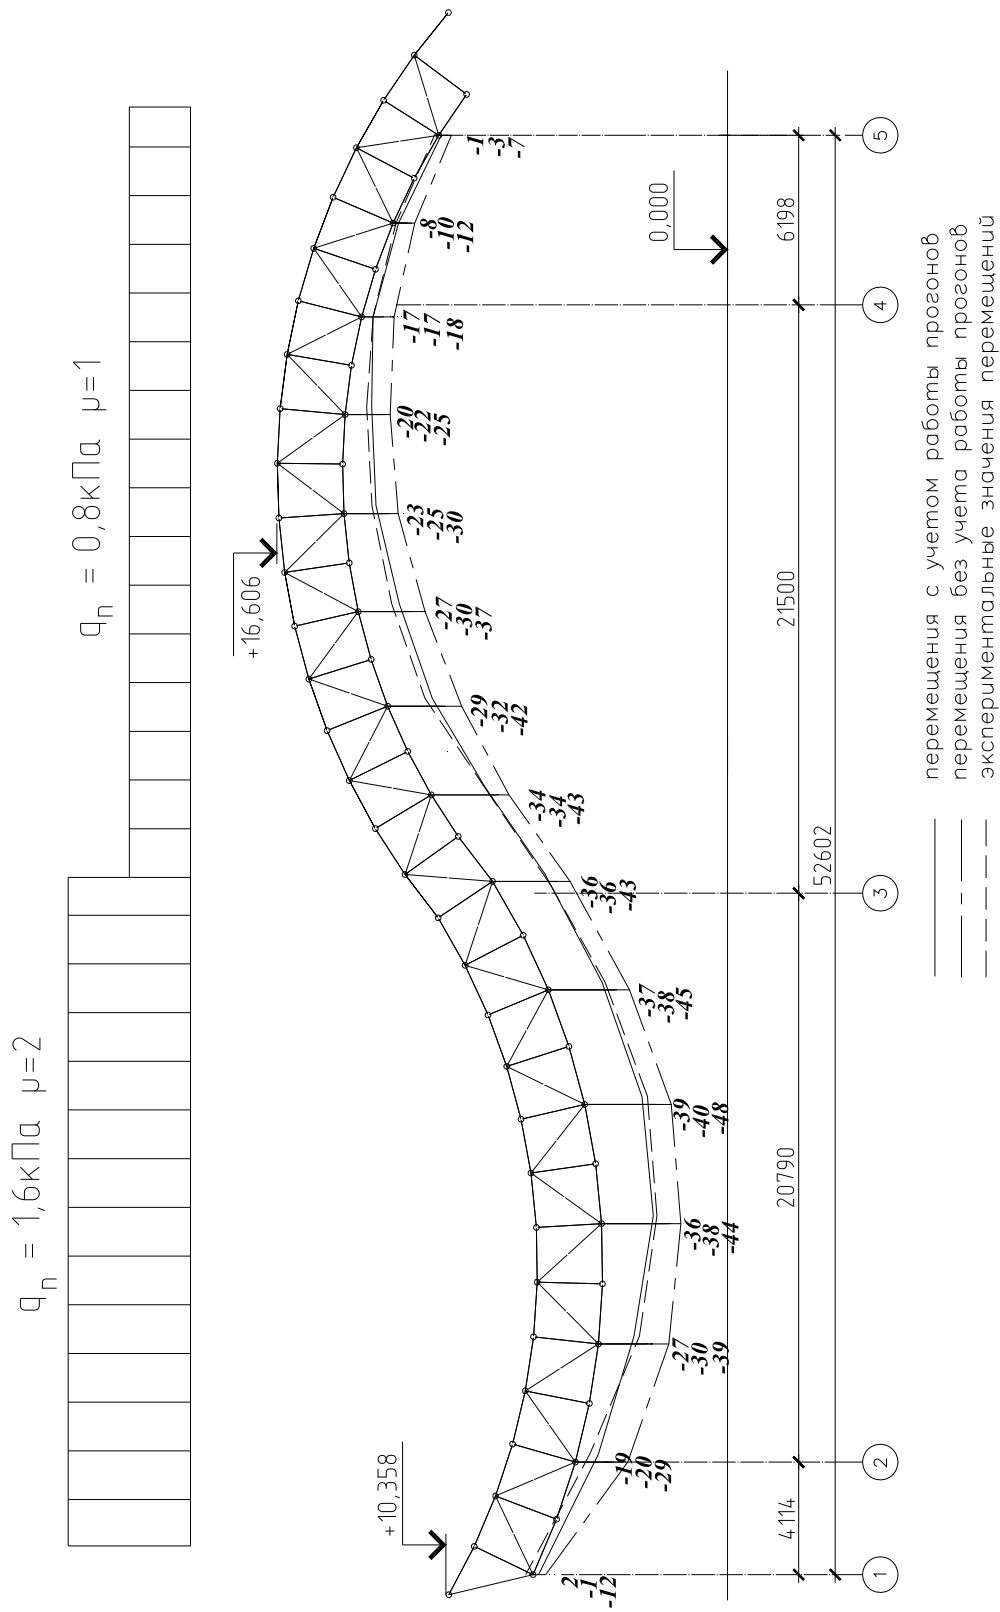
Схема загрузки покрытия снеговой нагрузкой и эпюры вертикальных перемещений узлов нижней поясной сетки по оси В при загрузении покрытия испытательной нагрузкой
